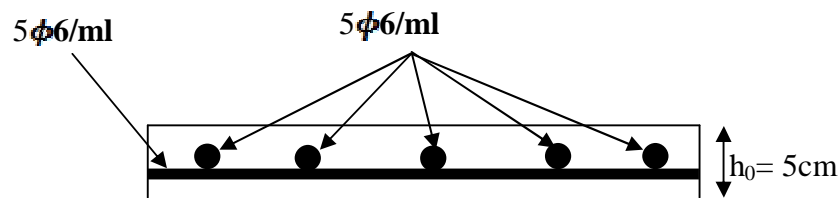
Schéma de ferraillage de la dalle de compression.
